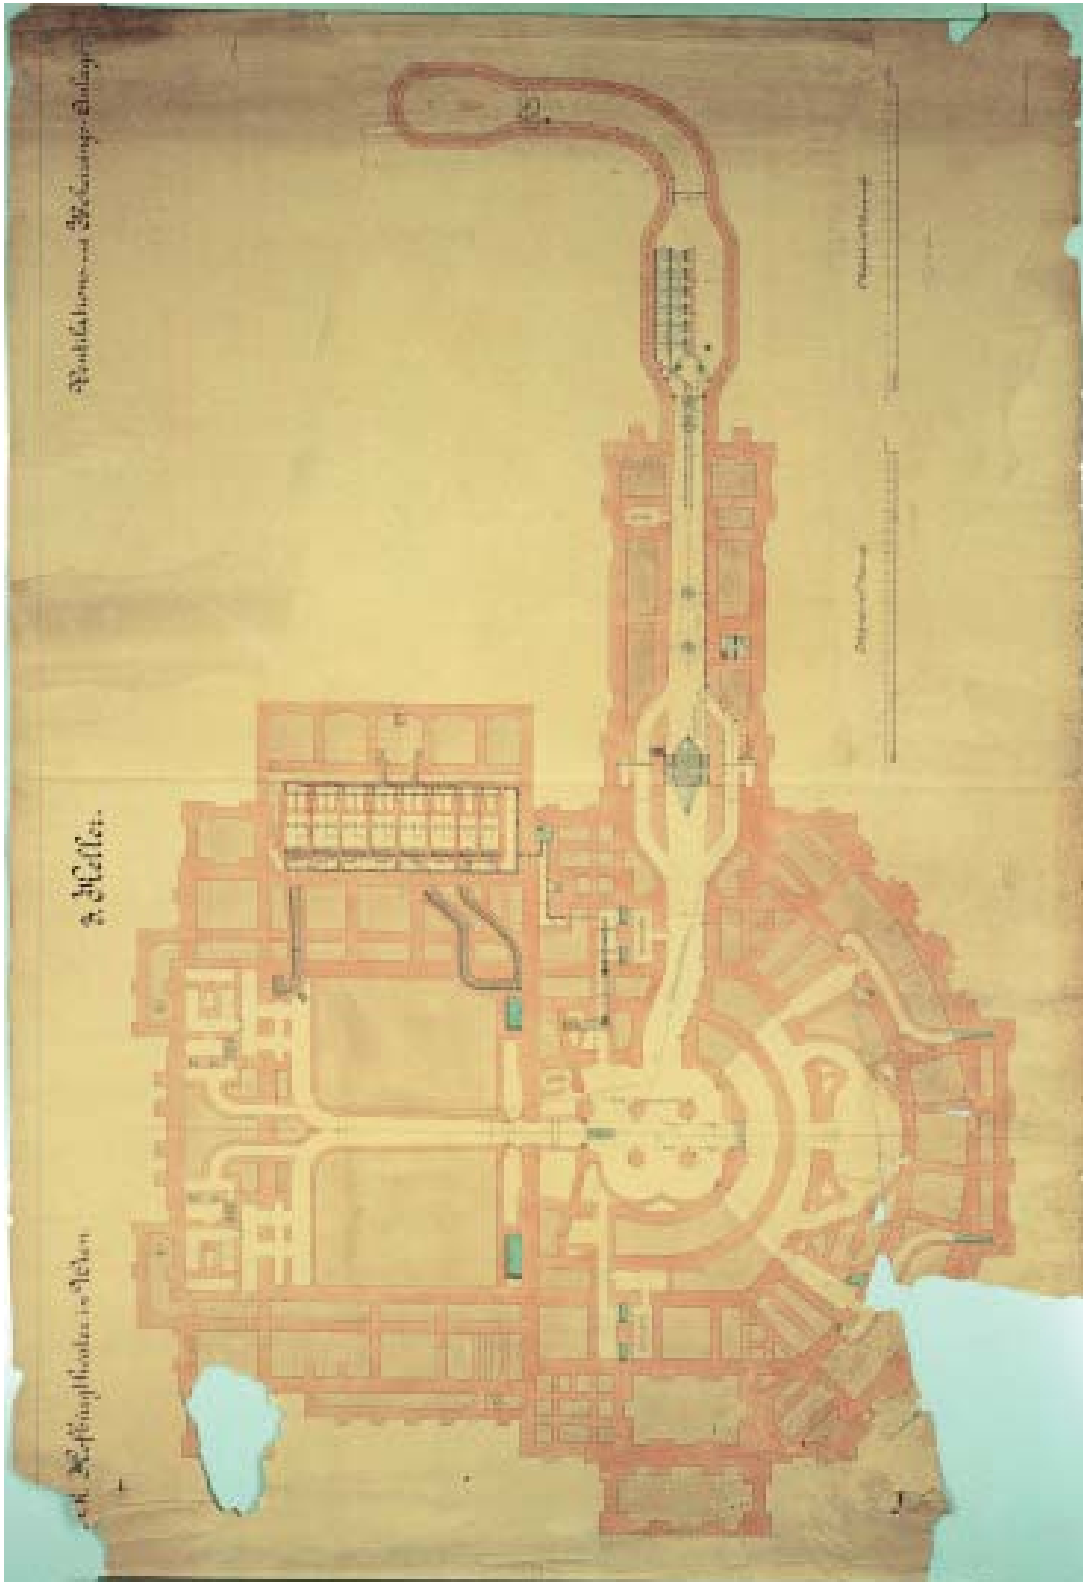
Grundriss des 3. Kellers im Burgtheater
